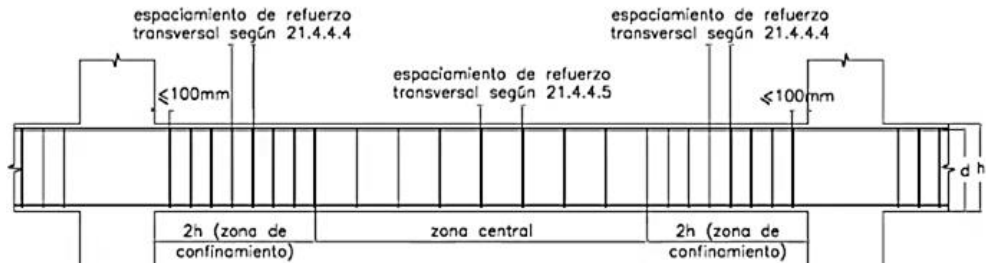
Requerimientos de estribos en vigas. Fuente: Norma E.060
